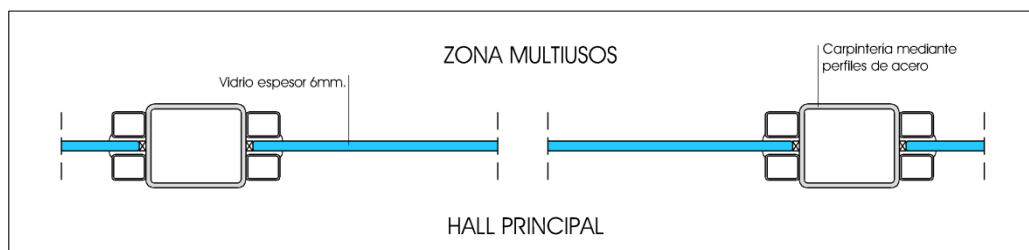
Detalle del elemento de separación de la Zona multiusos y Hall principal
